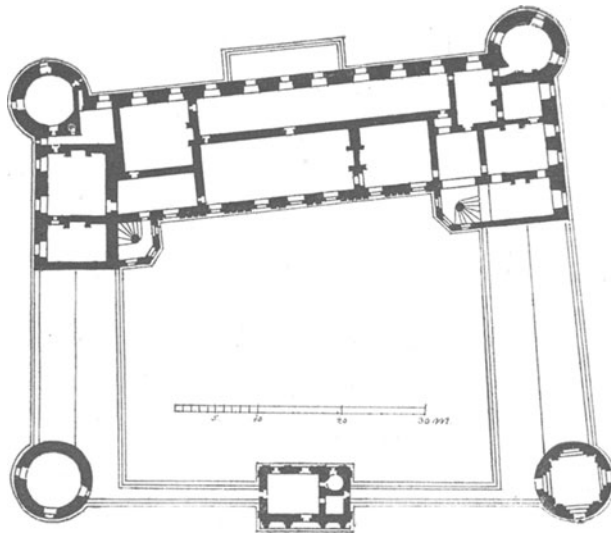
Château de Tanlay. Grundriss der 1. Etage.
